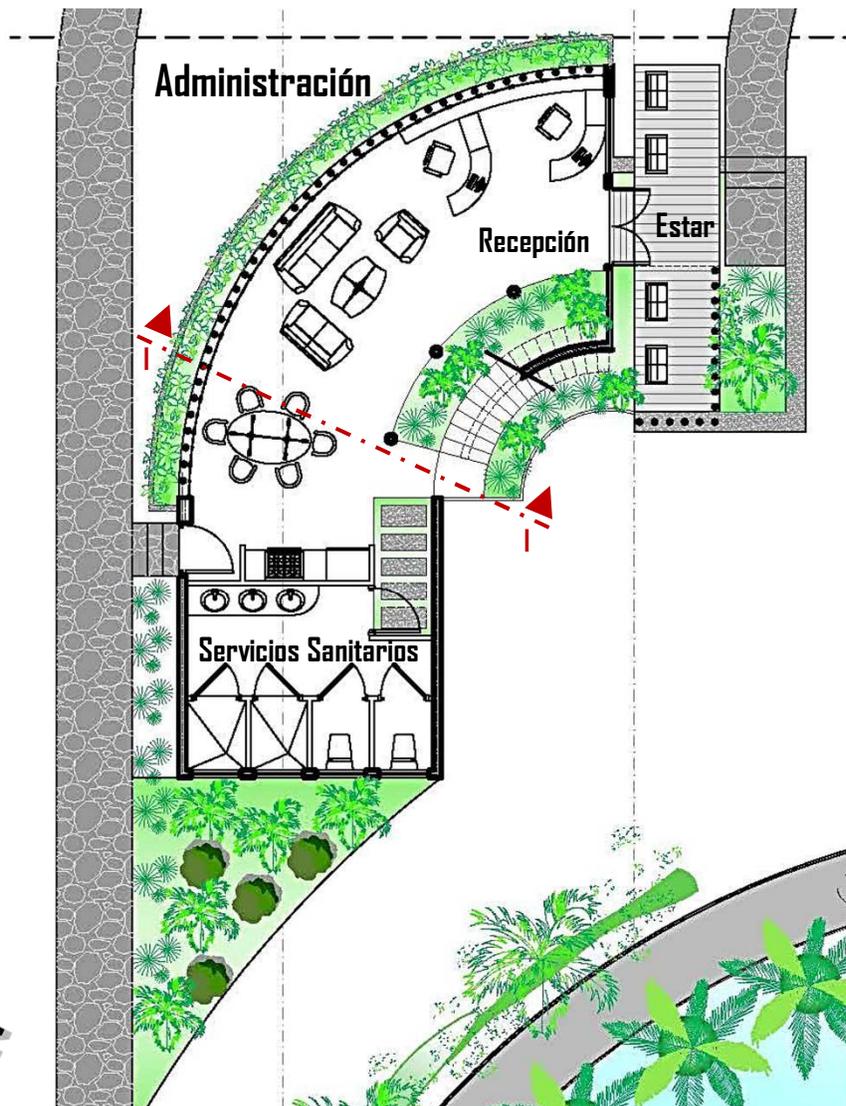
Planta de distribución arquitectónica Administración. 1er Nivel
